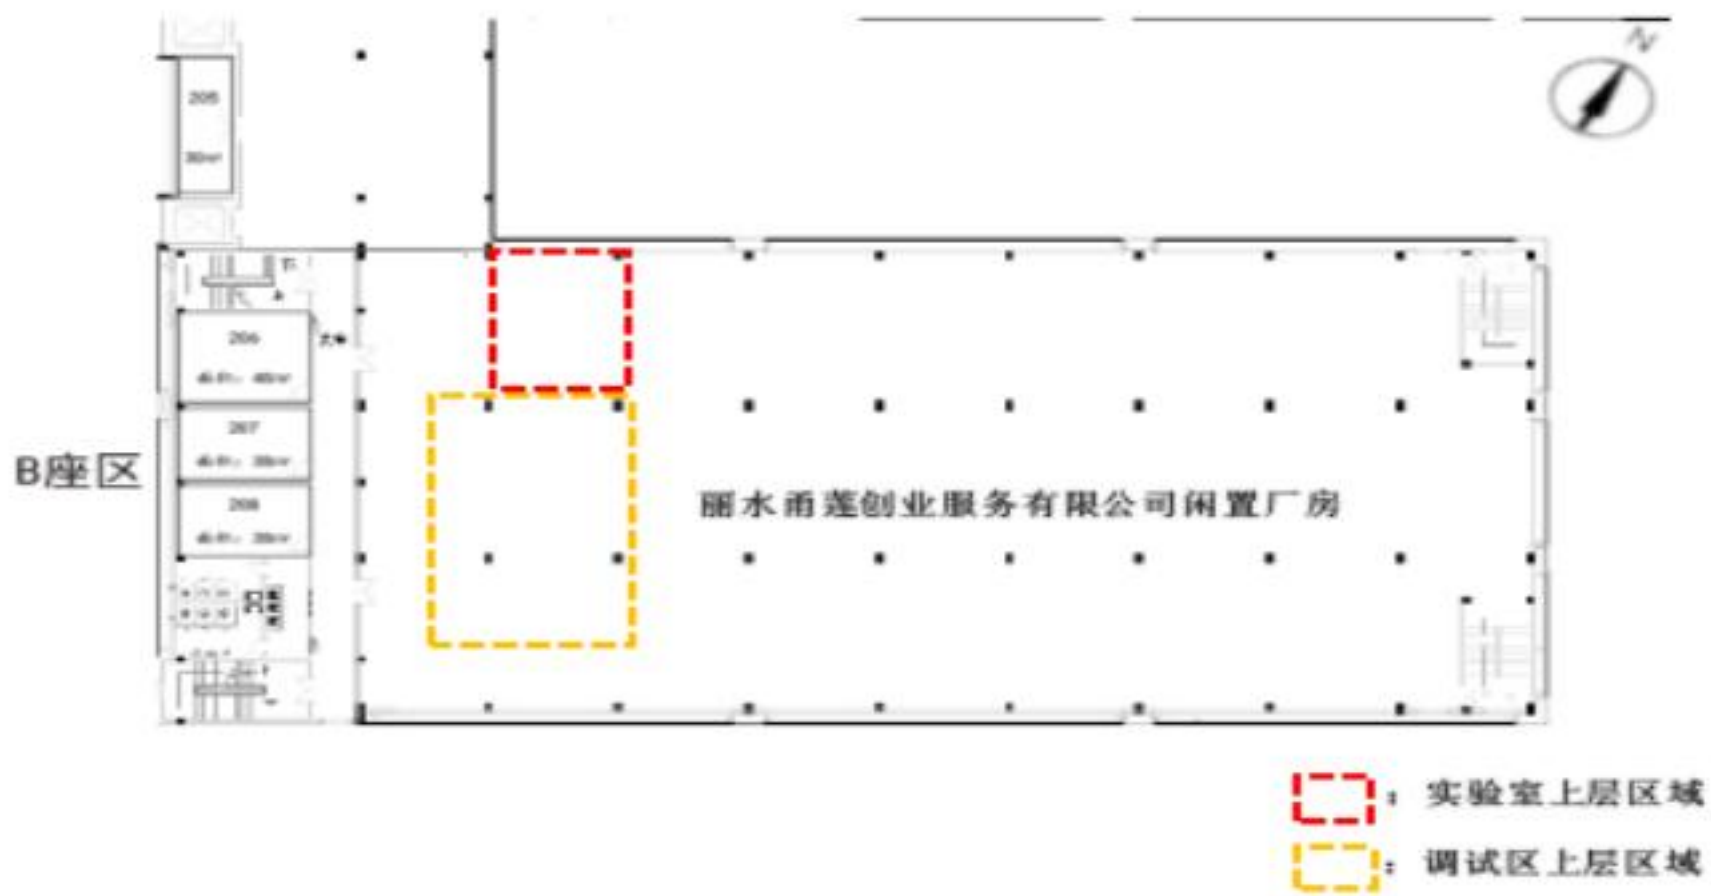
公司厂房一层平面图及实验室、调试区分区管理示意图
